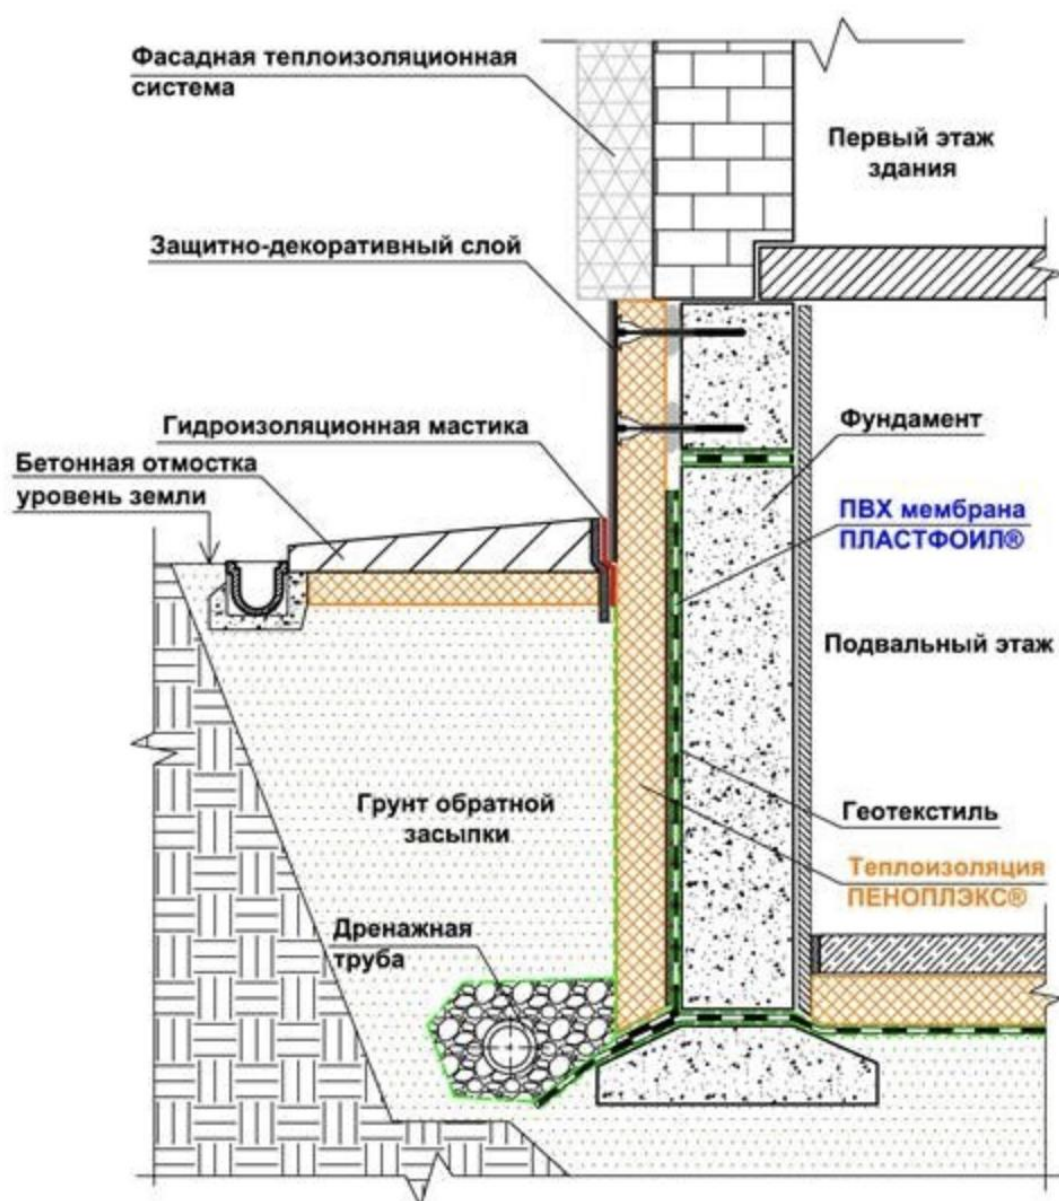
Принципова схема влаштування теплоізолюваних фундаментів підвалів (теплова ізоляція з зовнішнього боку).
